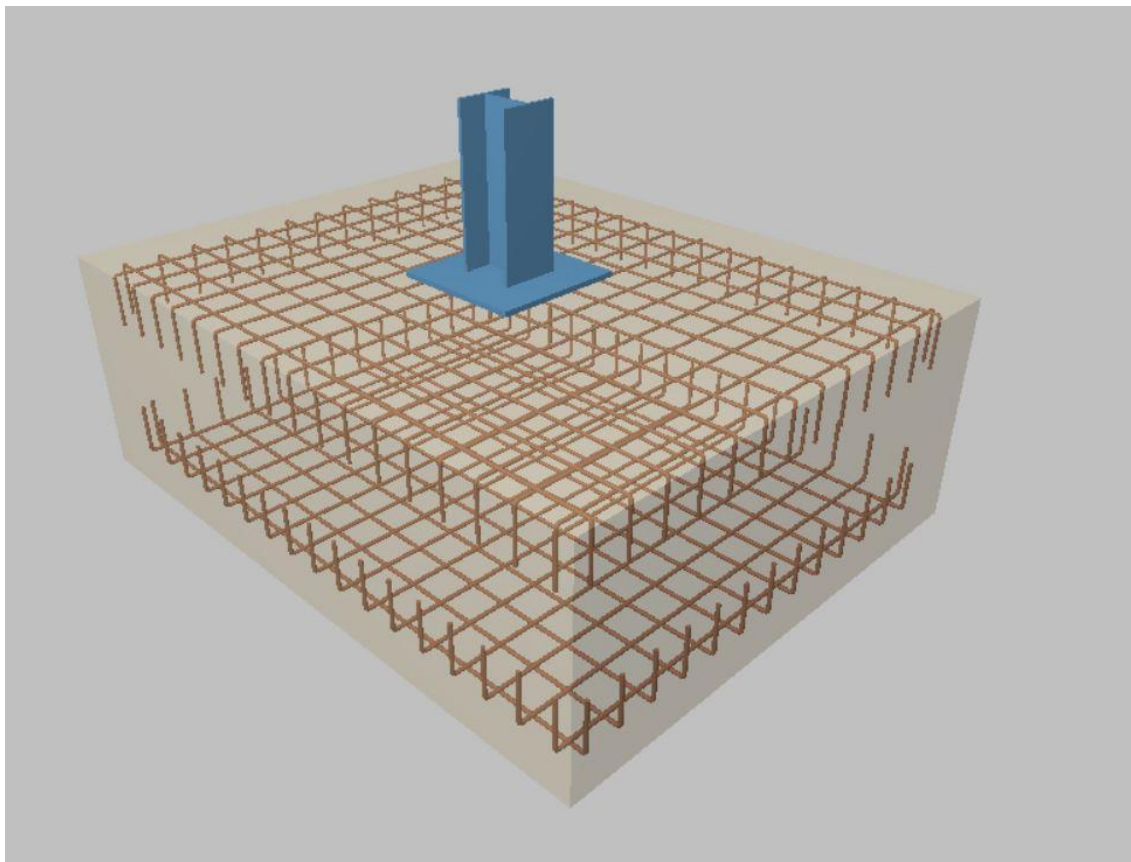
imagen de la zapata de fachada del primer pórtico y armado
